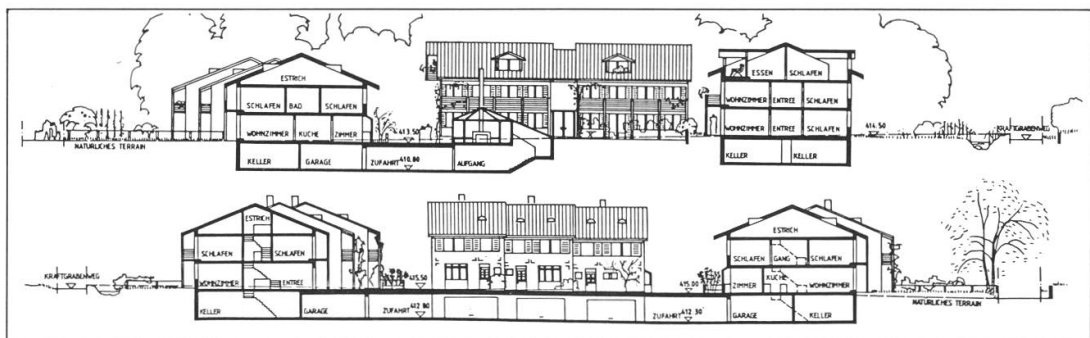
Schnitte Vorprojekt 1:200 (A-A und B-B in Abb. 13)
